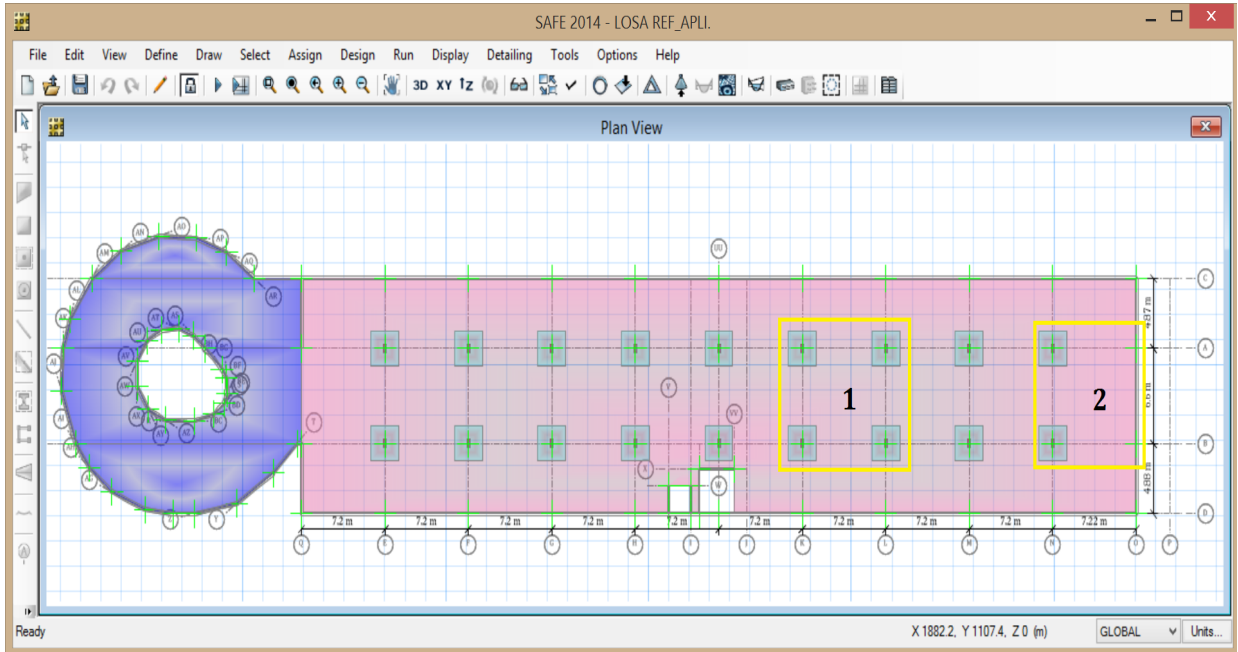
Paños de cálculo de ancho de fisura
